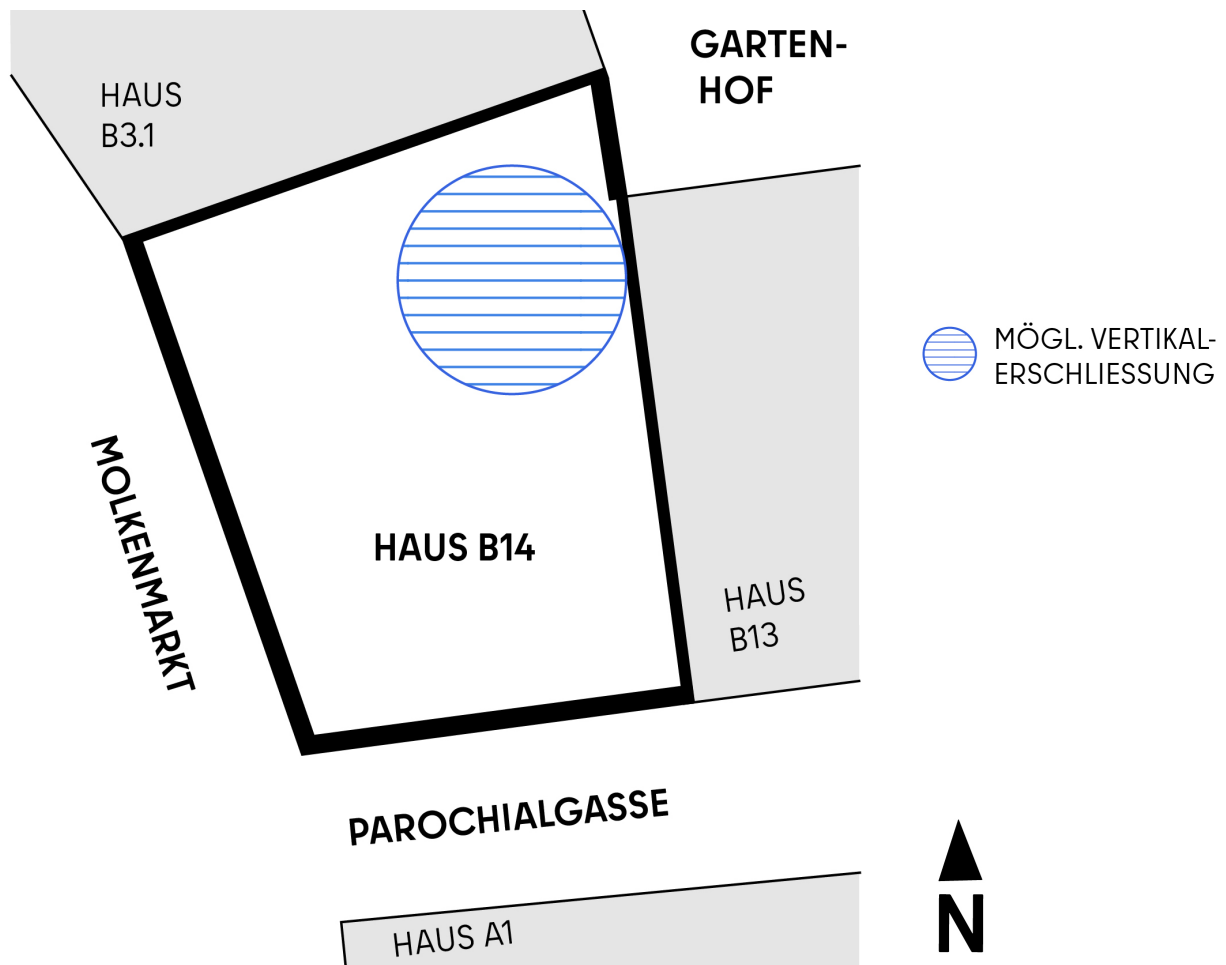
Schematischer Grundriss Untergeschoss
